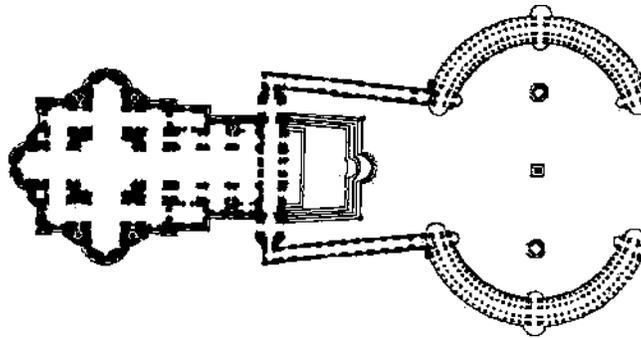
Planta de la Basílica renacentista de San Pedro, mostrando elementos tanto de planta central como longitudinal, <https://www.pinterest.es/>
